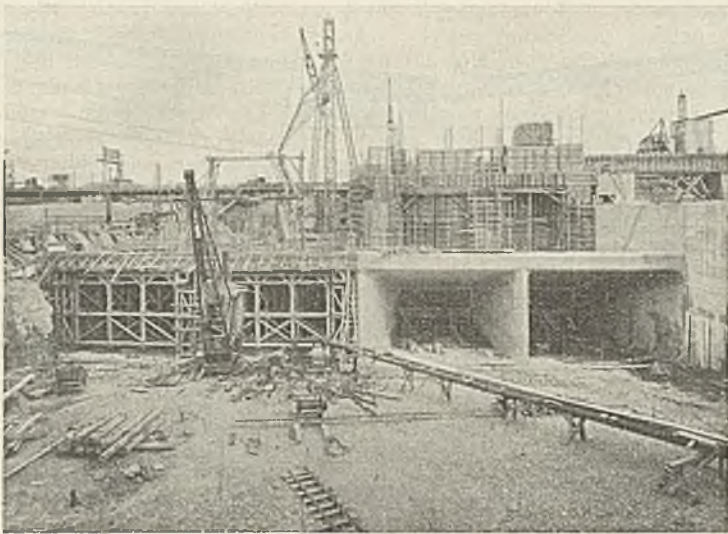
Kraithaus. Blick vom Unterwasser in die Baugrube.
